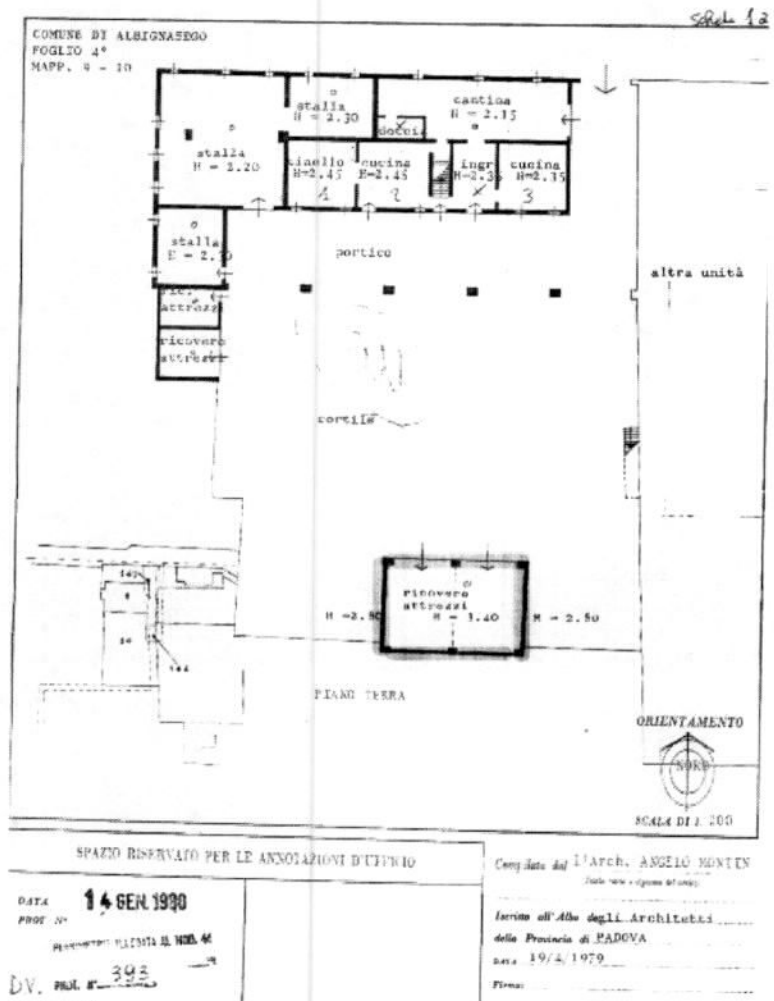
Planimetria catastale – SDF – Edificio oggetto di richiesta evidenziato in verde.
